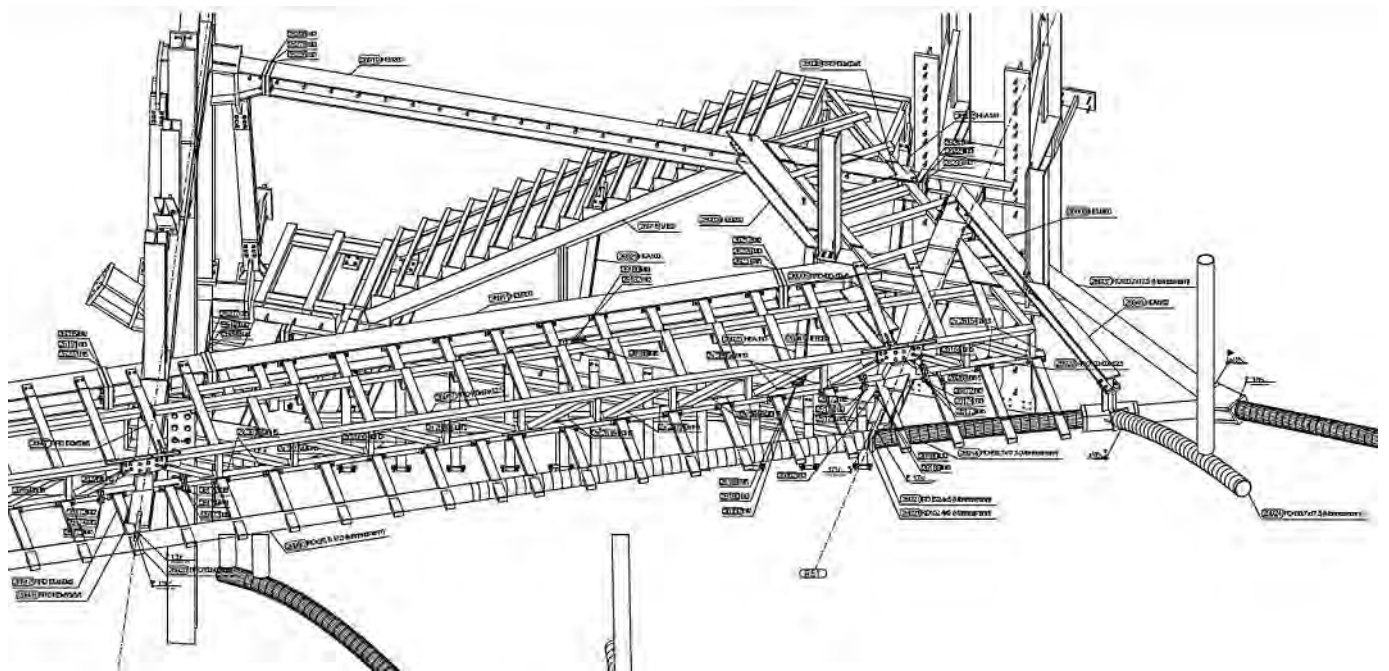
Ausschnitt der Werkstattplanübersicht zu einem Balkon (HASLINGER Stahlbau GmbH)
